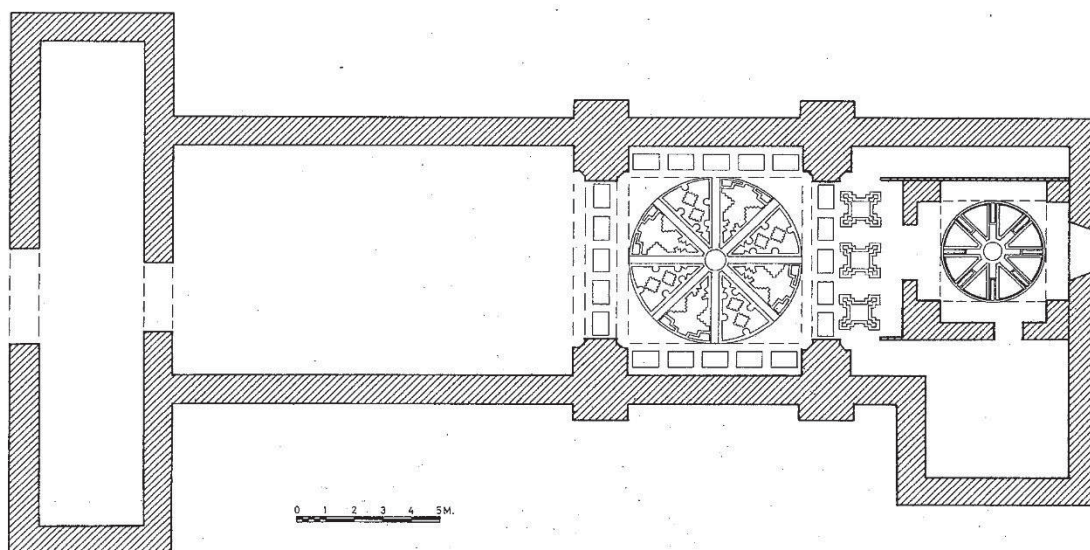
plano de la ermita de Villafrechós (fuente: ZALAMA RODRIGUEZ, M. A., Ermitas y santuarios..., p.162)
